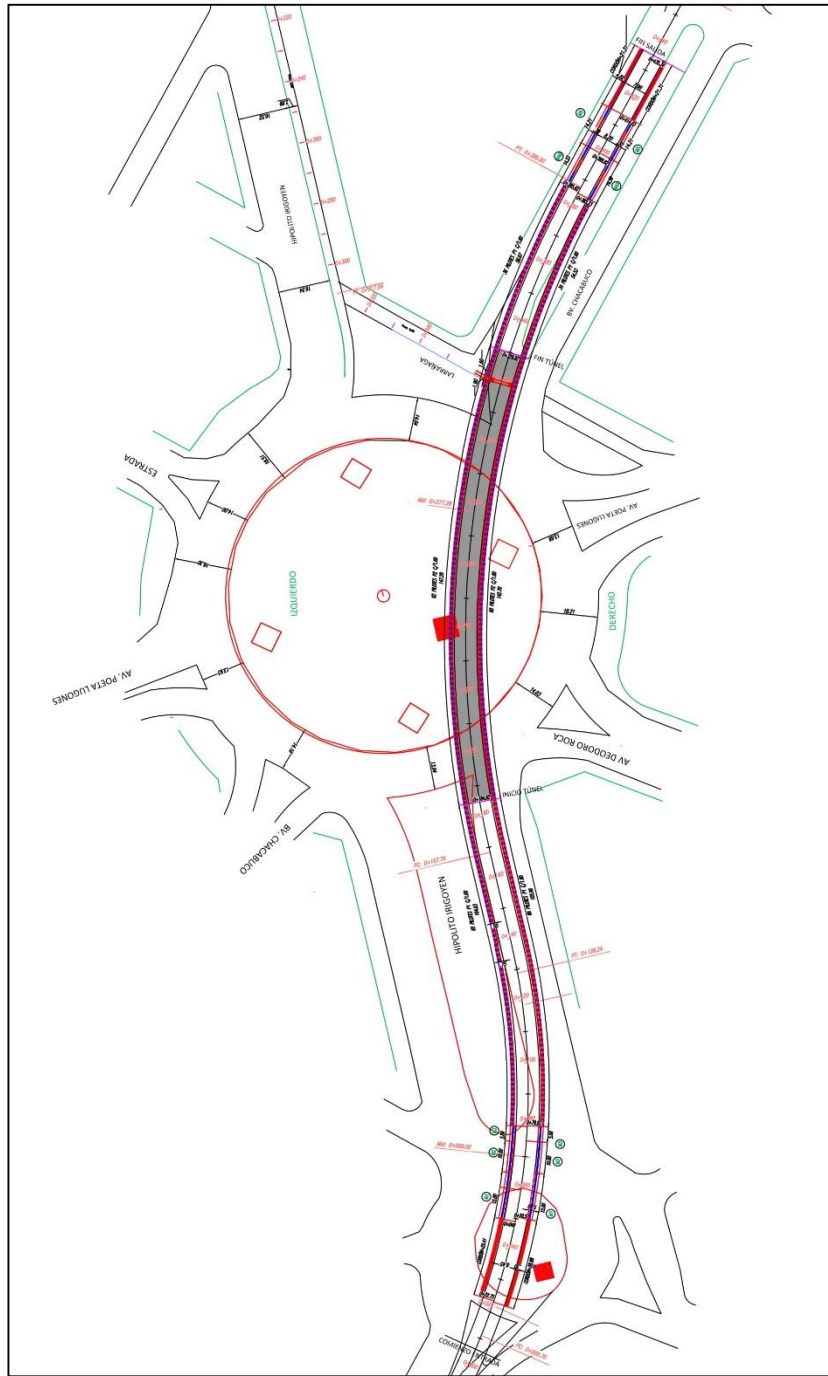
Planimetría general del viaducto. (PLANO N° 1)
